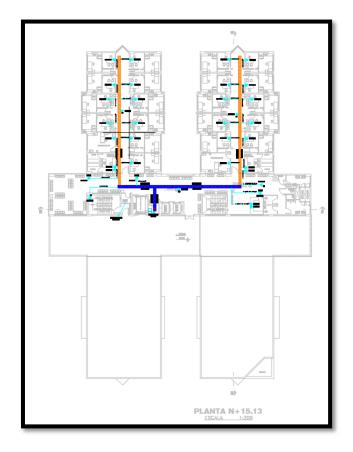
Plano cuarto piso implementado el cableado estructurado.
